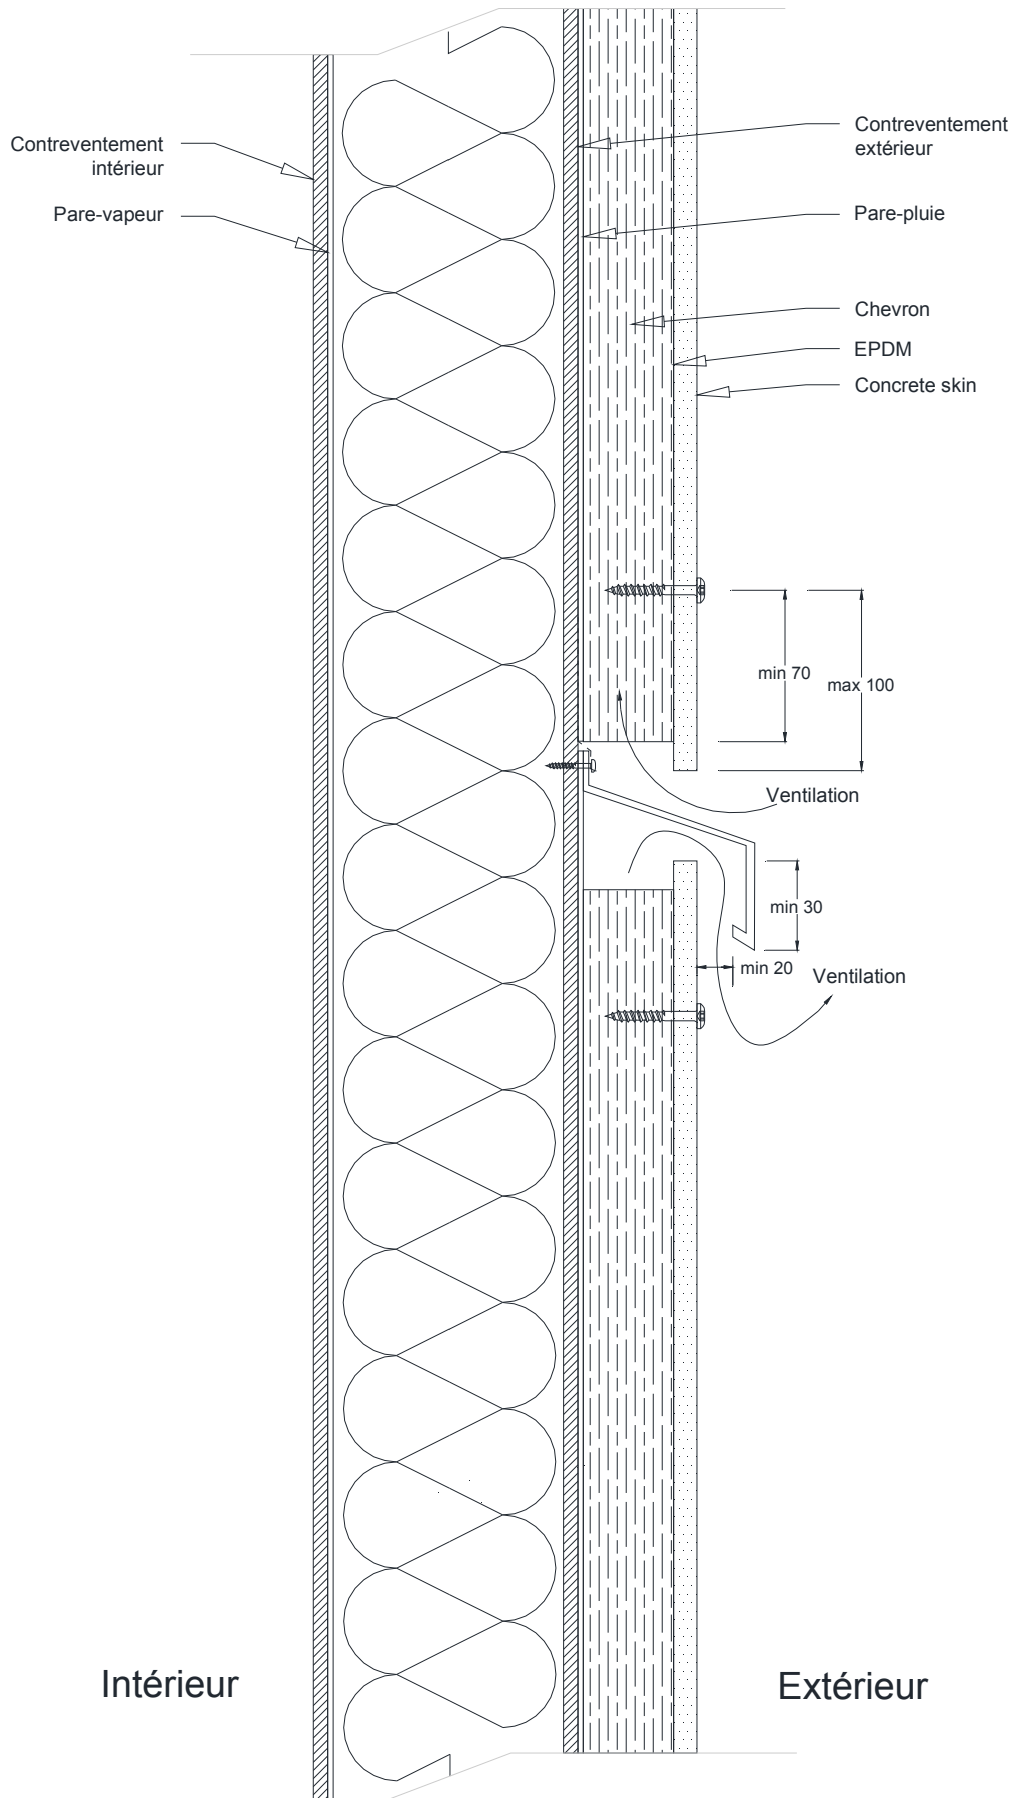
Pose sur COB – Recouvrement du pare-pluie tous les 6m
